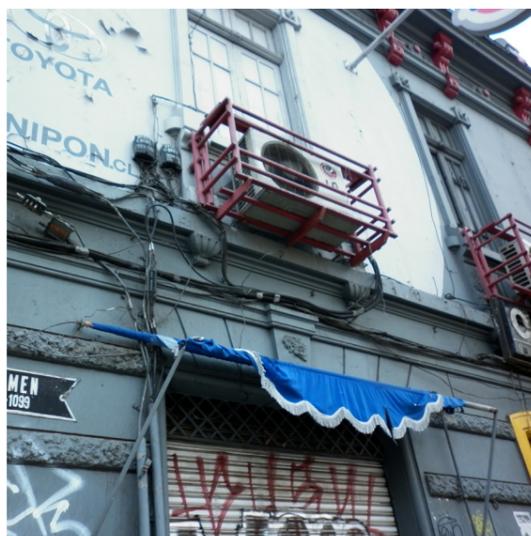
Equipos de aire acondicionado, instalaciones eléctricas en fachada. Fuente: Fot. autores (2014).
